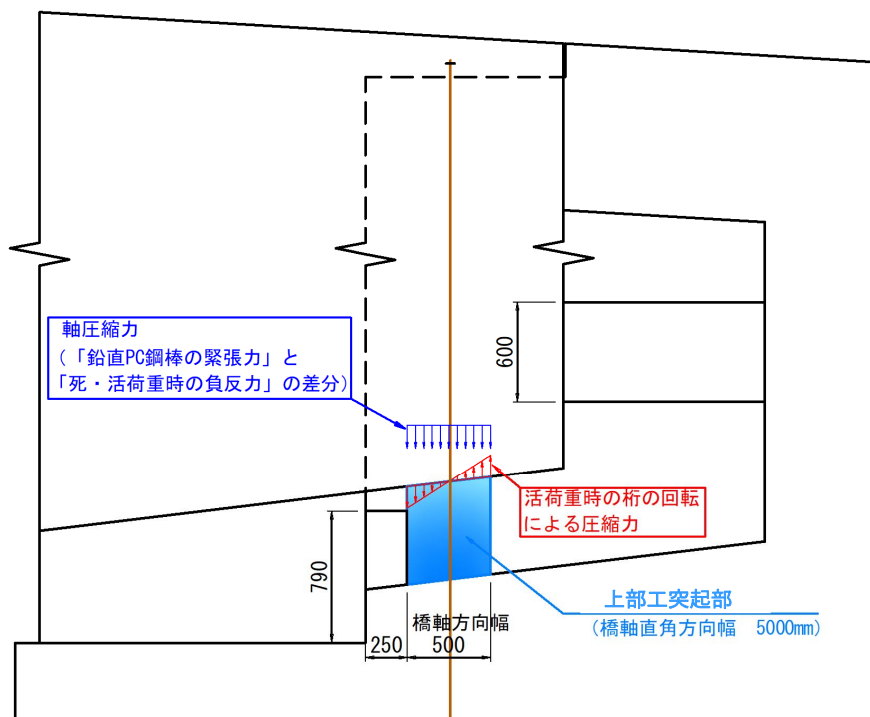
上部工突起部に作用する荷重（死荷重＋活荷重時）
